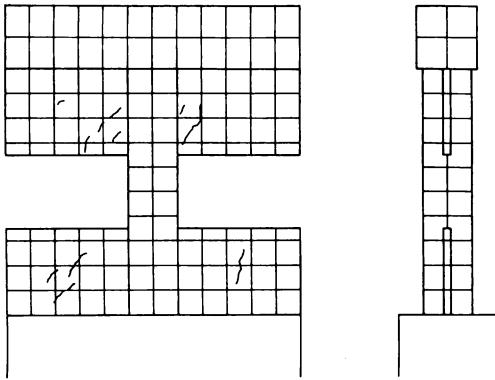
(b) 試験体 CSS02 の初ひび割れ図
